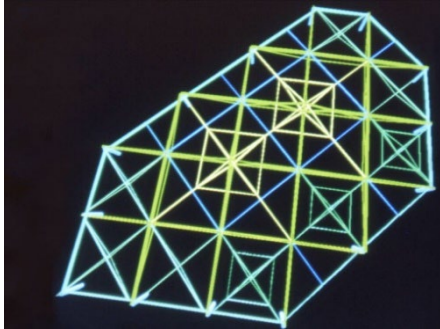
Grundriss des diagonalen Haupt- (gelb) und Sekundärtragwerks (blau)
